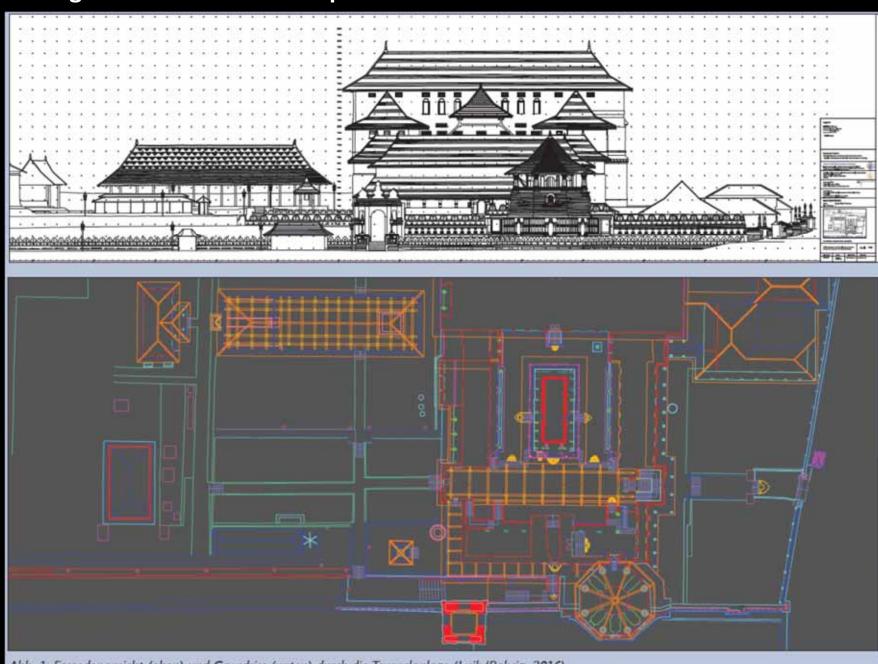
Fassadenansicht (oben) und Grundriss (unten) durch die Tempelanlage (Luib/Rahrig, 2016)
